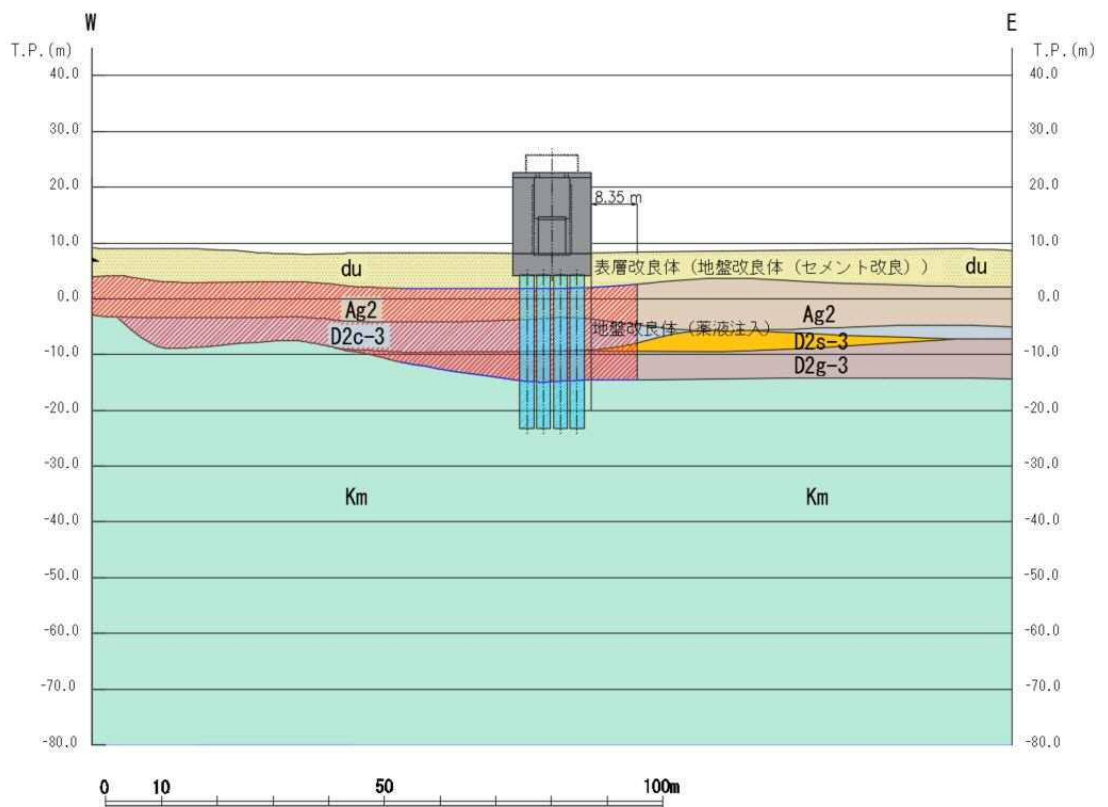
(2) 評価対象断面図 (B-B断面)
